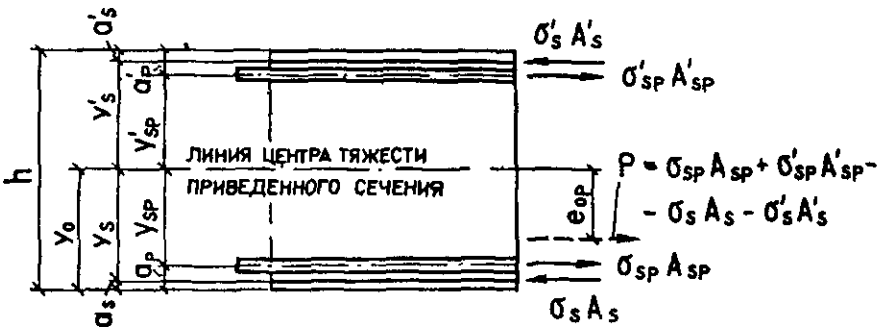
Схема усилий предварительного напряжения арматуры в поперечном сечении железобетонного элемента
